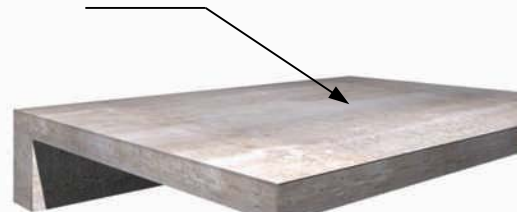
Losa de hormigón o radier sobre la cual se instalará un revestimiento de madera.
